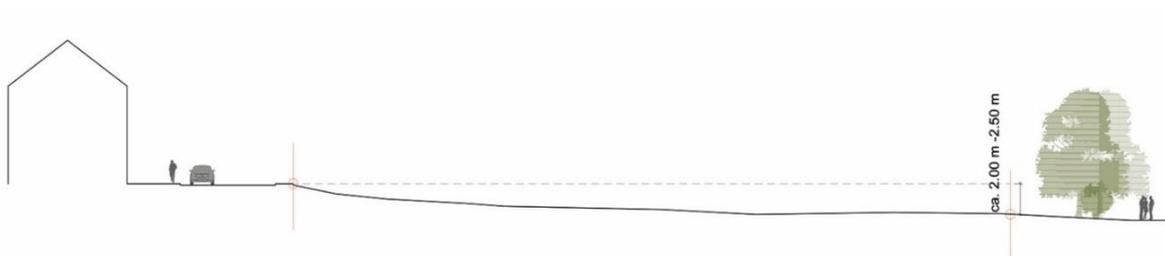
Bestands-Geländeprofil West-Ost. Links im Bild: Herressener Straße
